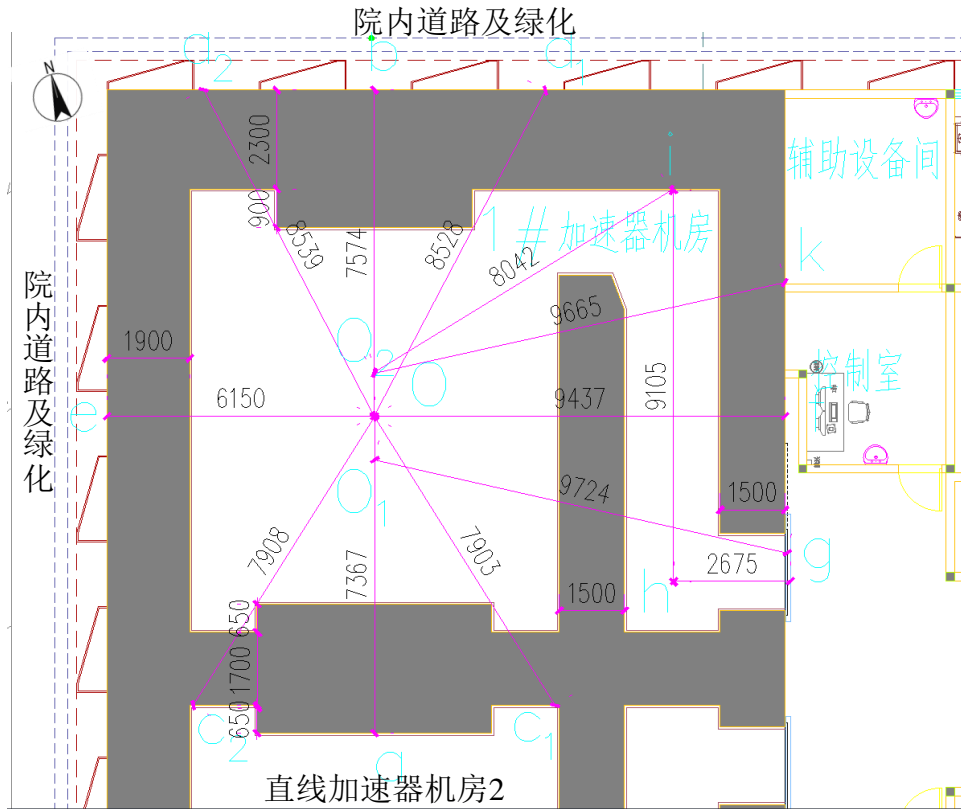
加速器机房平面布置图 (单位 mm)
